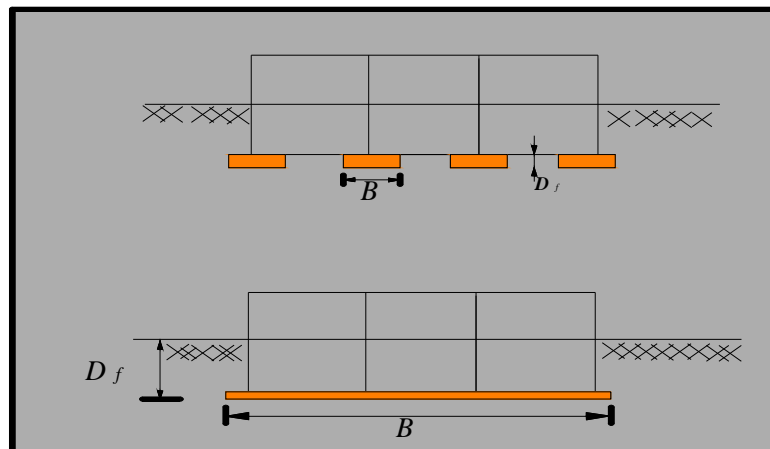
Comparación entre Zapatas aisladas y losas de fundación (B =ancho, D_f = profundidad)
